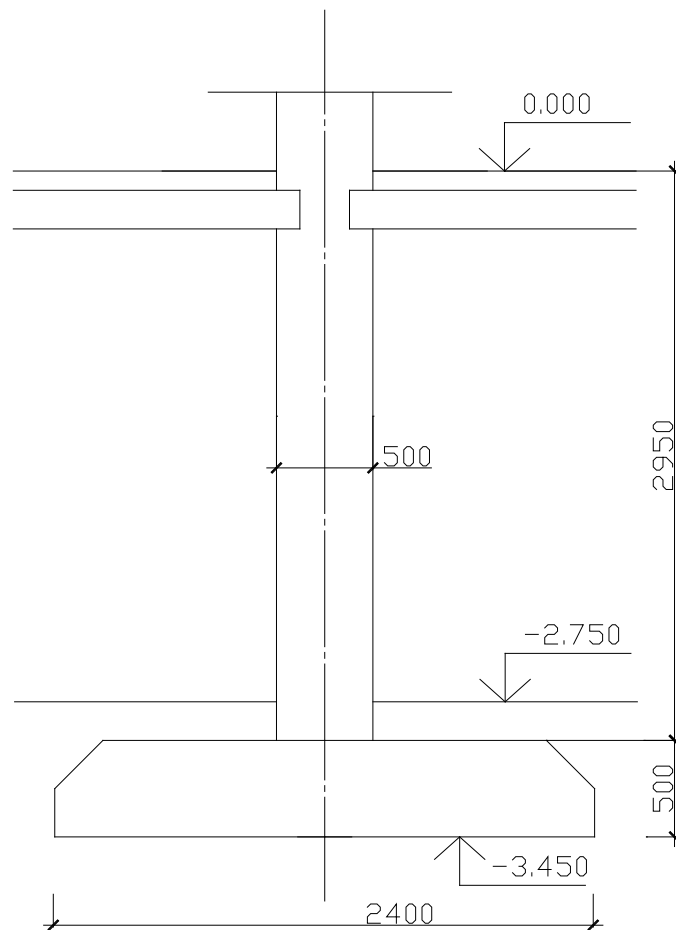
Поперечний переріз збірного залізобетонного фундаменту (Варіант 1).
